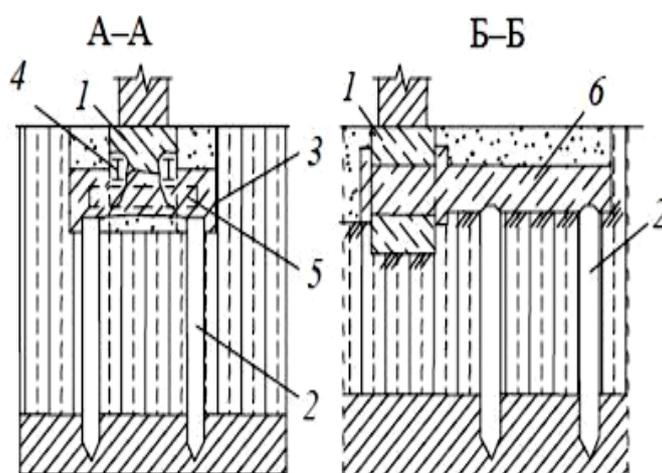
Усиление ленточных и бутовых фундаментов: *1* – усиливаемый фундамент; *2* – свая; *3* – ростверк; *4* – рандбалка; *5* – поперечные балки; *6* – рычажный ростверк
